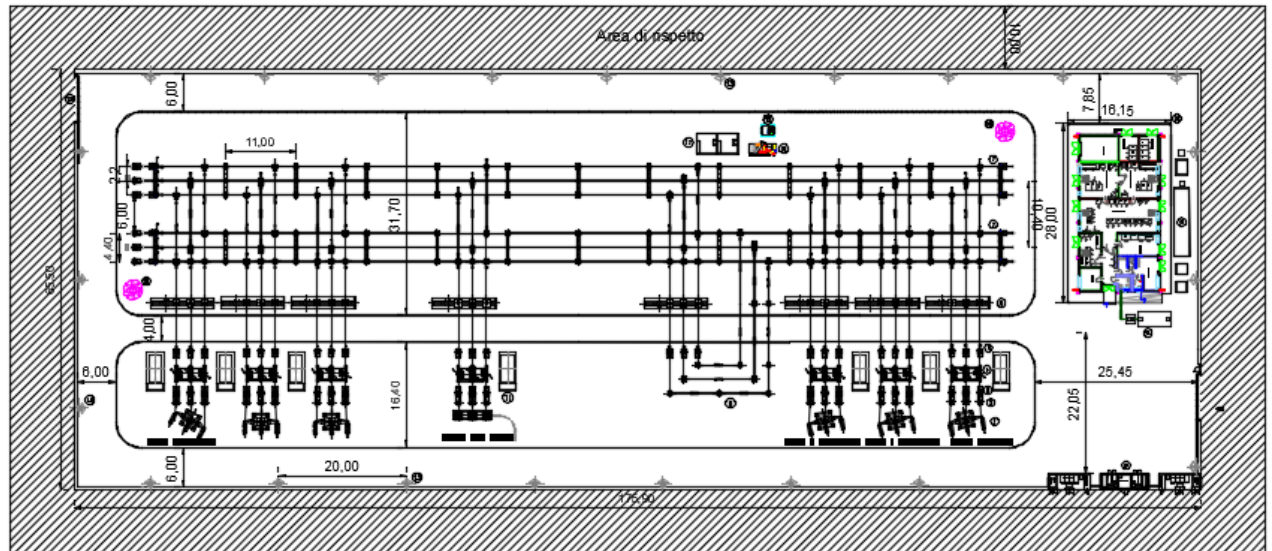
Planimetria elettromeccanica SE Camerino RTN
